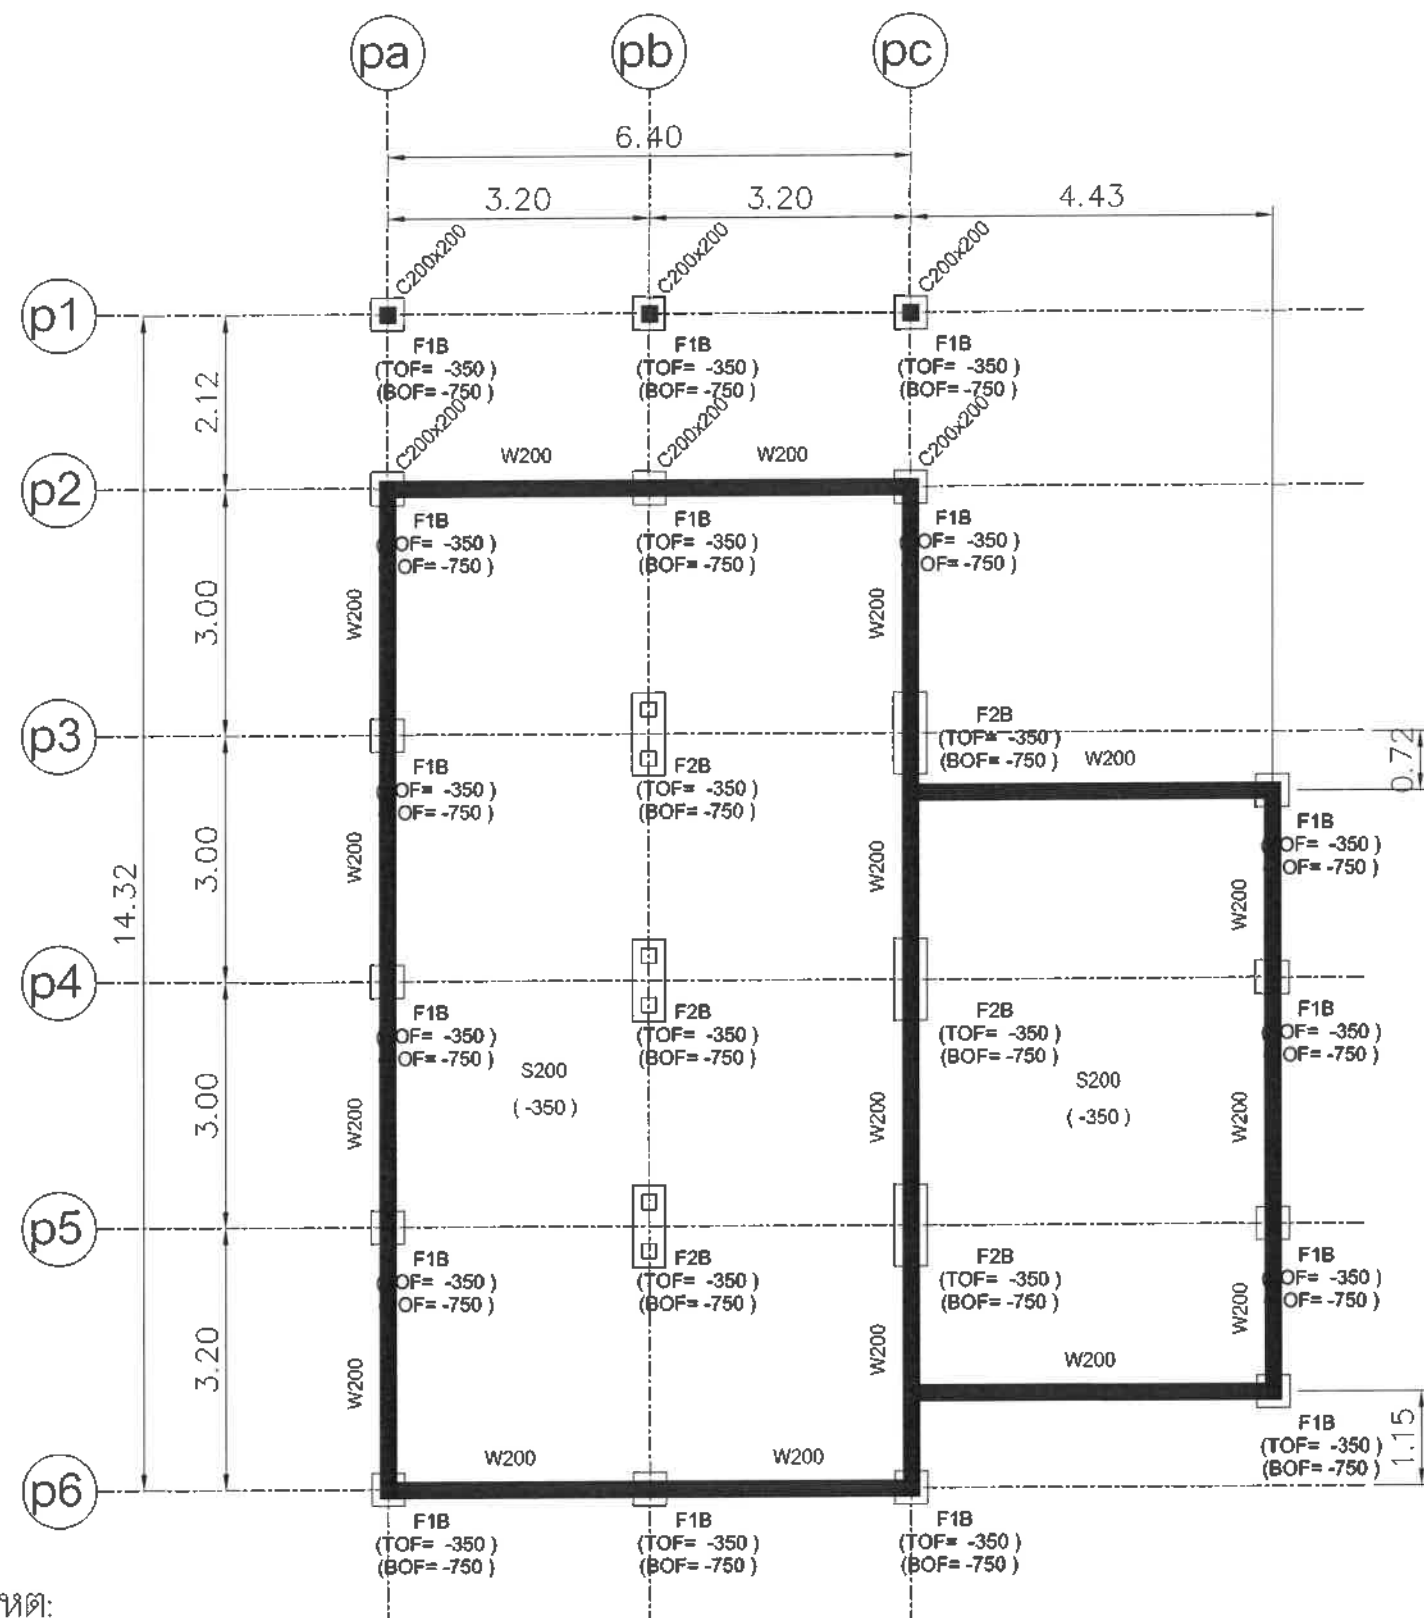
แปลนแสดงแนว Sheet Pile อาคารโรงแรม
